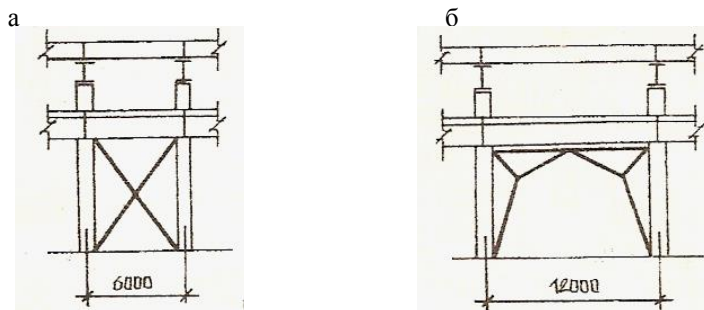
Вертикальные связи по железобетонным колоннам:
